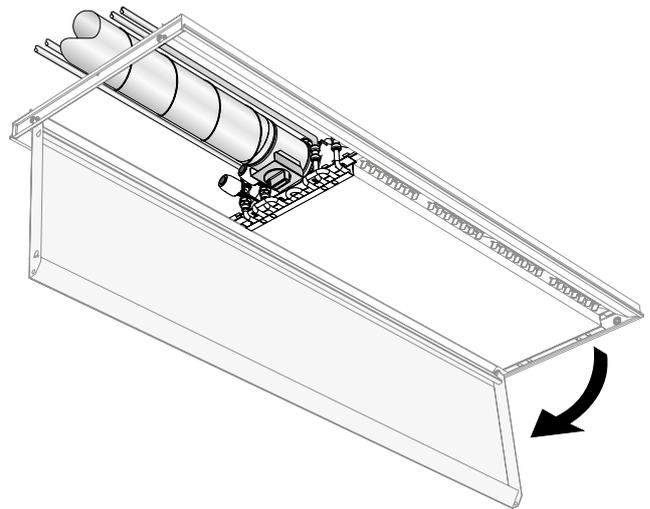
Exemple d'accessibilité à une section inactive avec raccords rectilignes horizontaux via la façade du module de parement.
